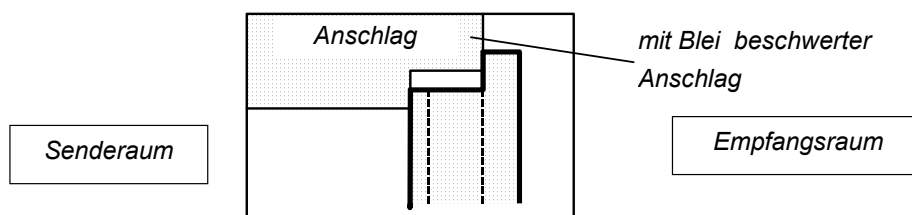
hochschalldämmendes Element (Prinzipskizze des eingebauten Elementes)
